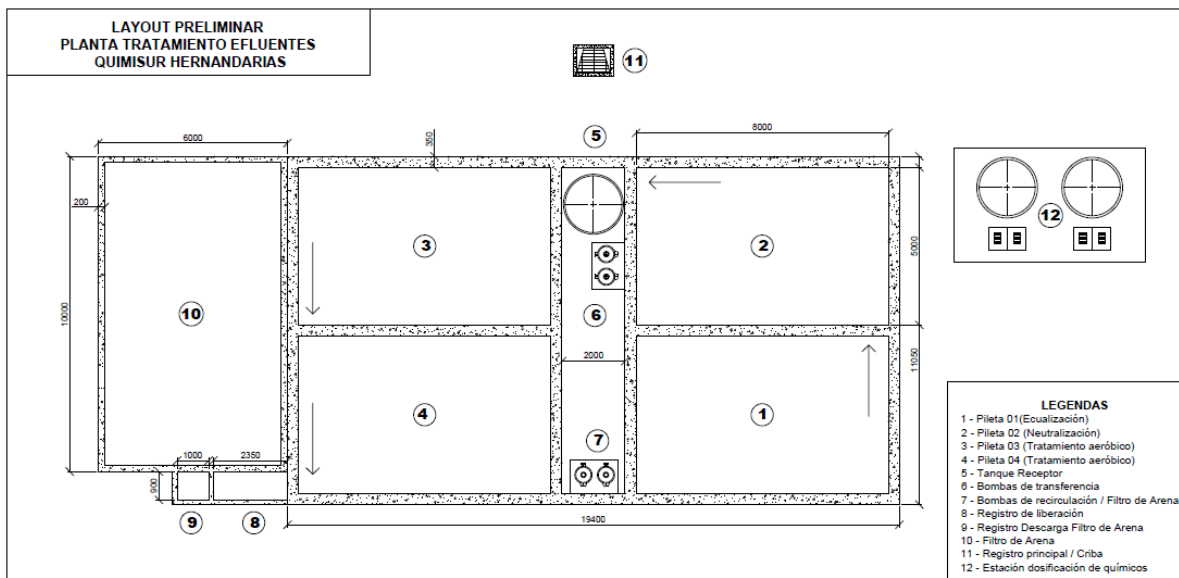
Layout* de la Planta de Tratamiento de Efluentes (proveído por el proponente).
